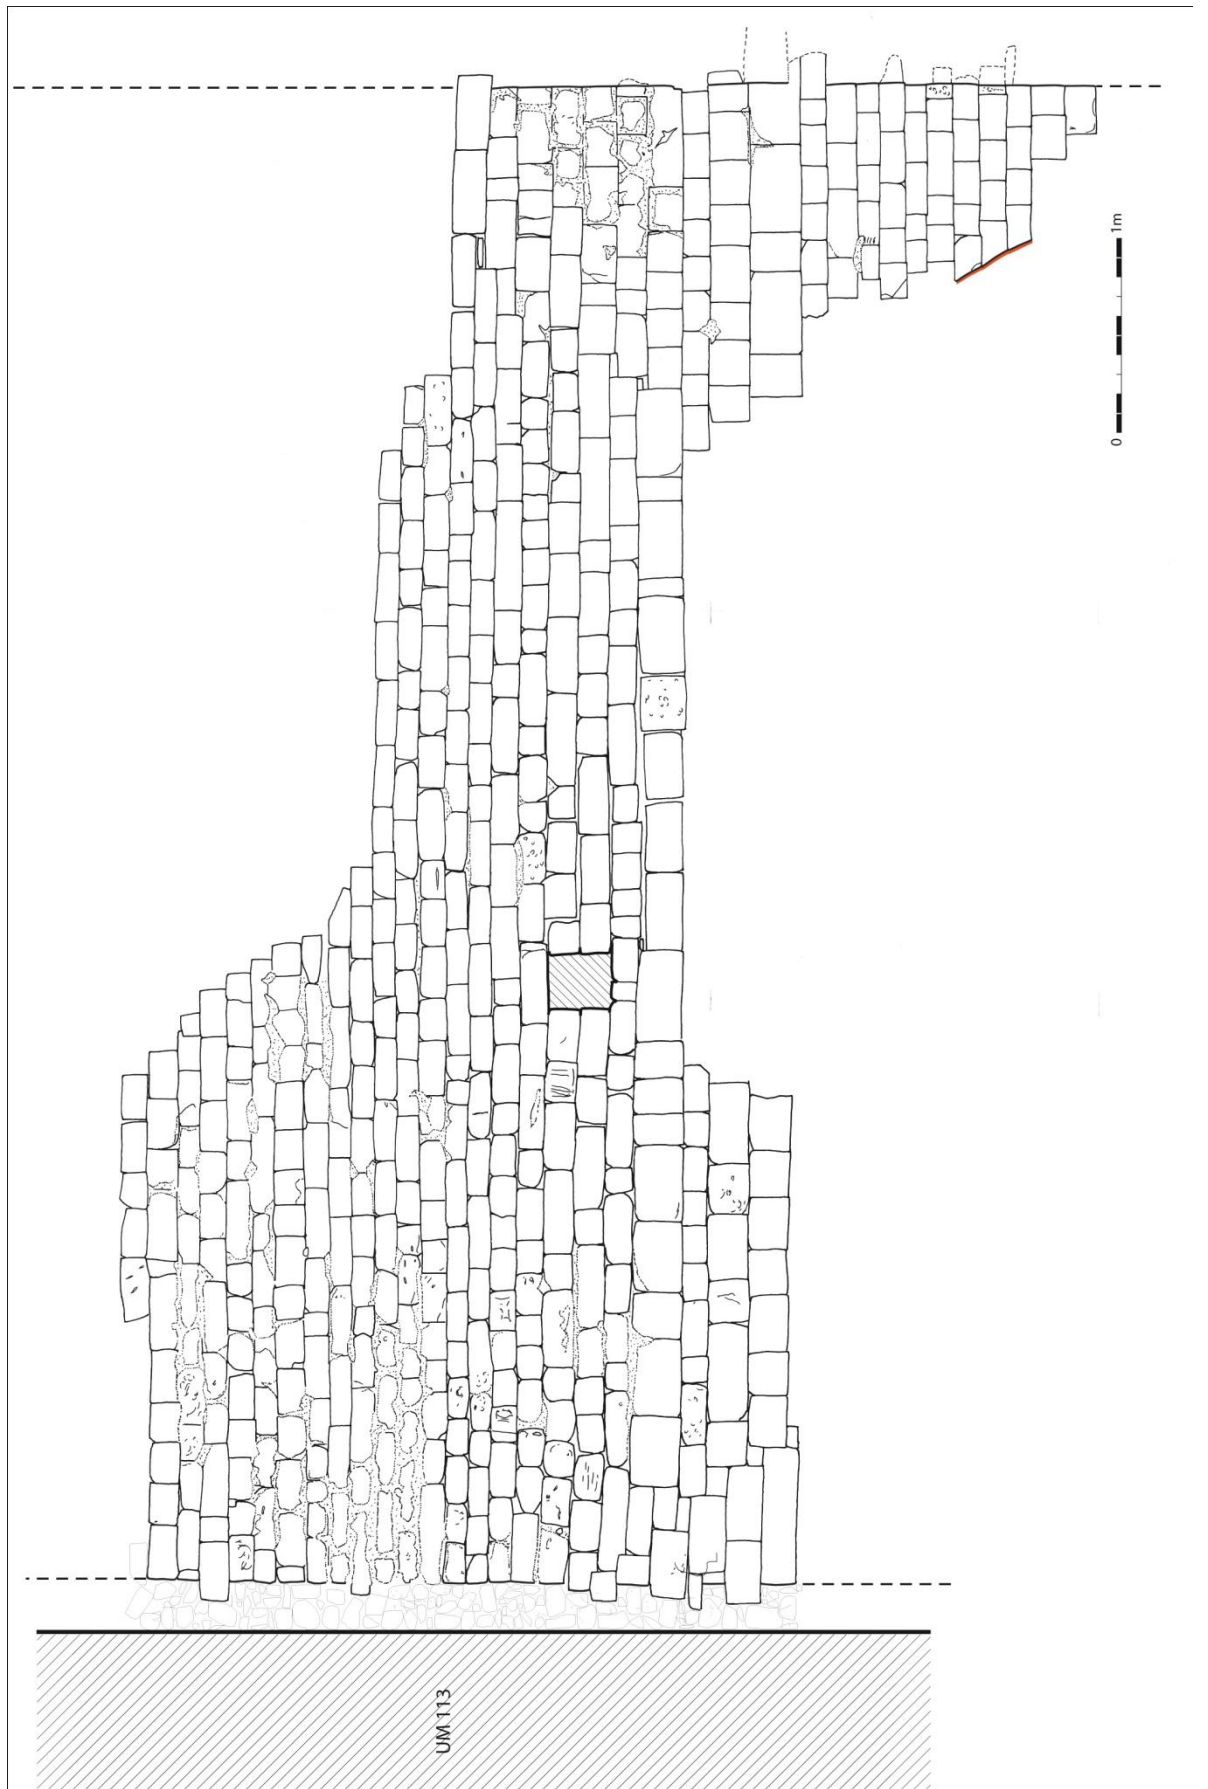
Relevé de la façade sud du mur de façade (relevé et D.A.O. : M. Varano).
